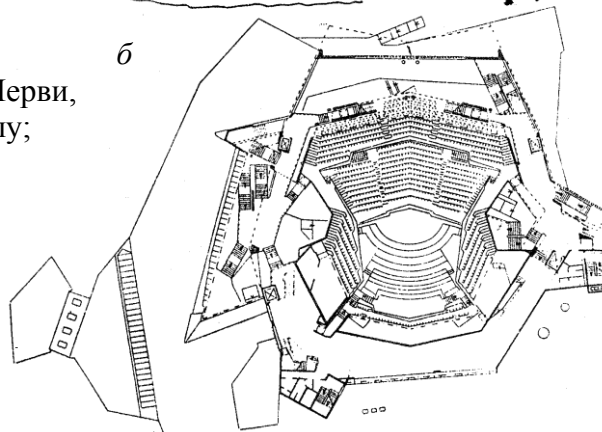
Здание филармонии. Берлин, 1956–1963 гг.: *a* – перспектива; *б* – план
